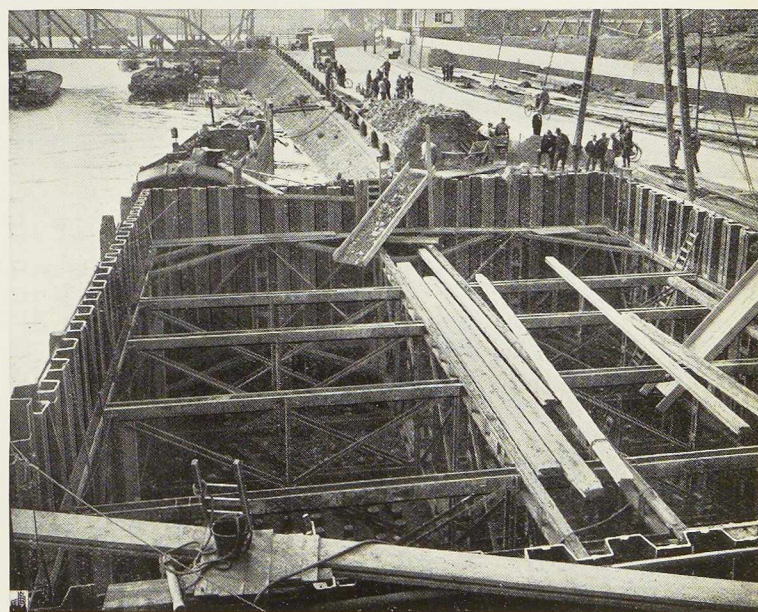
Construction d'une pile du nouveau pont-rail de l'Oosterdok à Amsterdam. Les palplanches Belval Z III et Z IV ont 14 et 19 mètres de longueur. Tonnage global : 1.442 tonnes.
